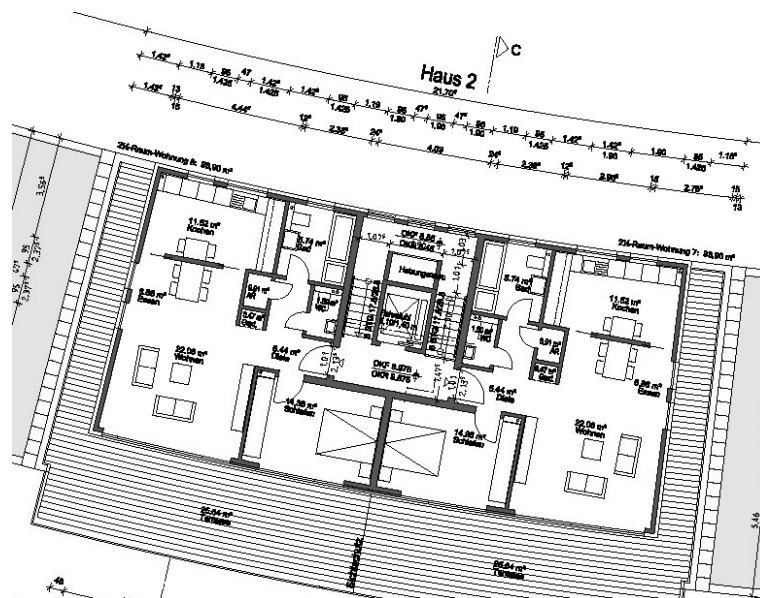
Grundriss Neubau (Rübsamen + Partner)
